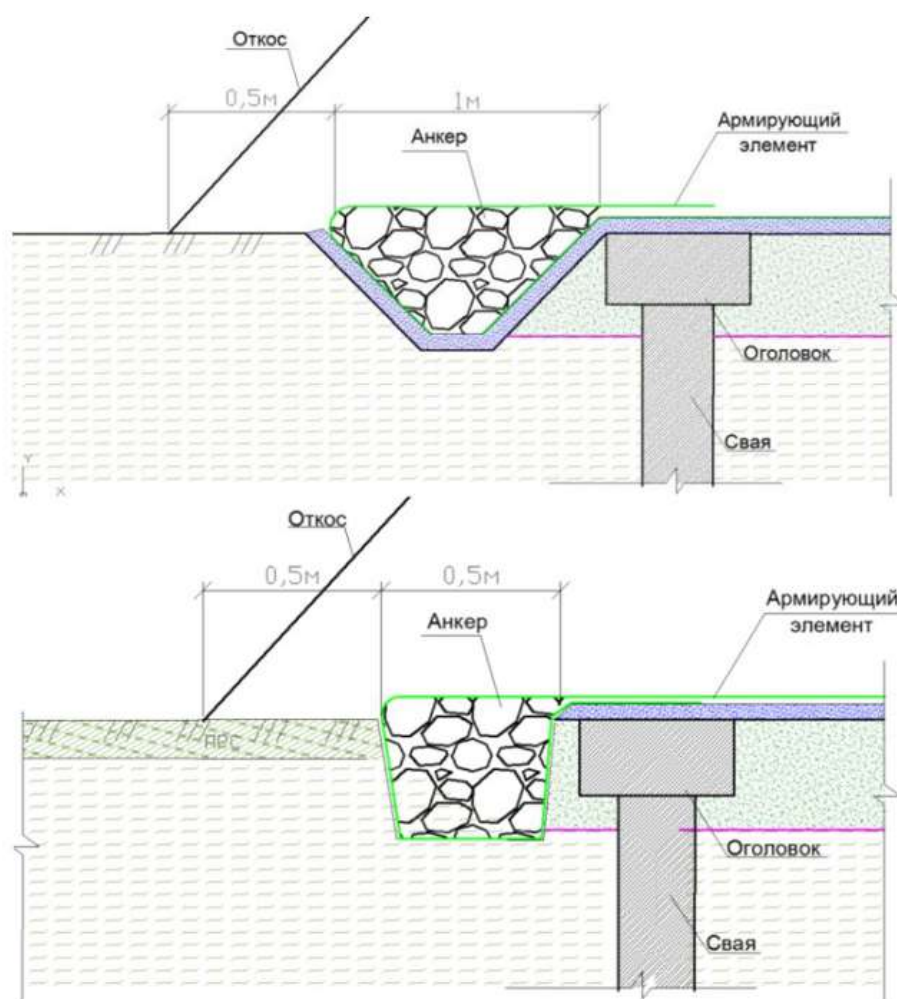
Схемы конструктивных решений по анкеровке армирующего элемента
